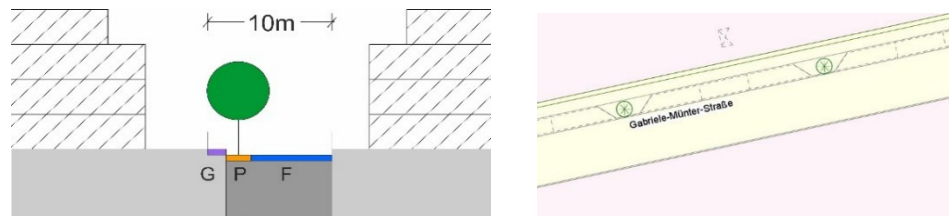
Anliegerstraße, Schnitt- / Lageplan, Eigene Darstellung 2020
